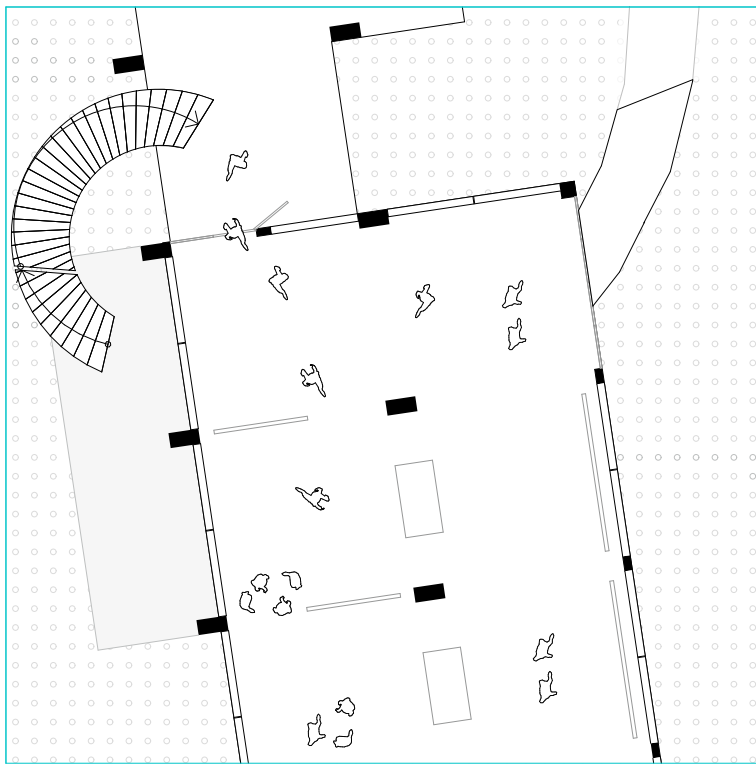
Ausschnitt Grundriss 2. Ebene 1:200
